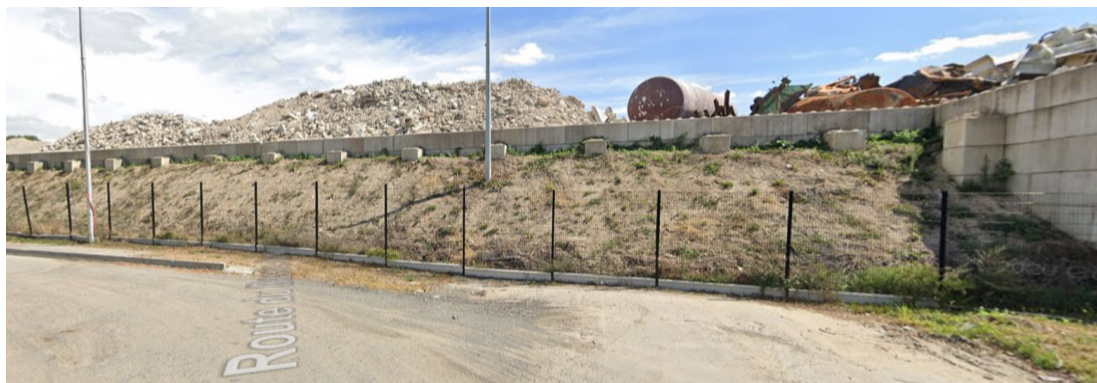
Enceinte interne blocs béton préfabriqués, site MAZEAU RECYCLAGE en regard Est du site de méthanisation projeté
